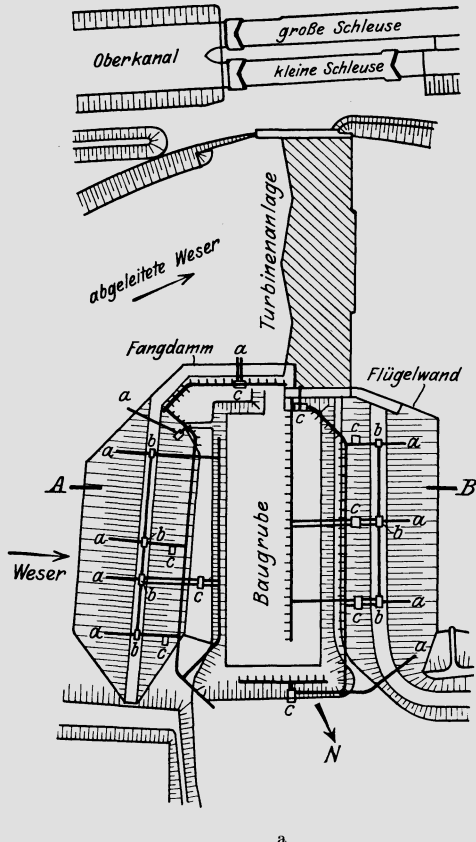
a u. b. Sektorwehr Bremen, Baugrube. Maßstab 1 : 1500.
